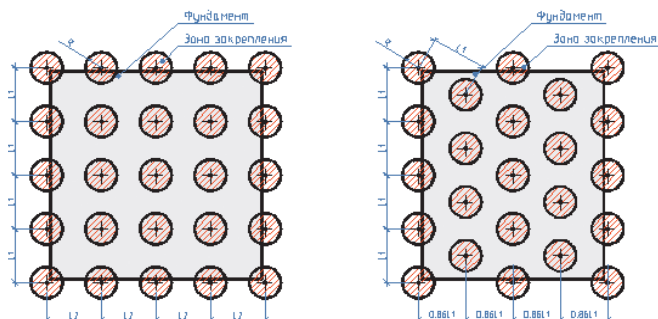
Частичное усиление грунта в плане для плитных фундаментов: а – закрепление плитного фундамента по линейной схеме при $L1 \approx L2$; б – закрепление плитного фундамента в шахматном порядке
